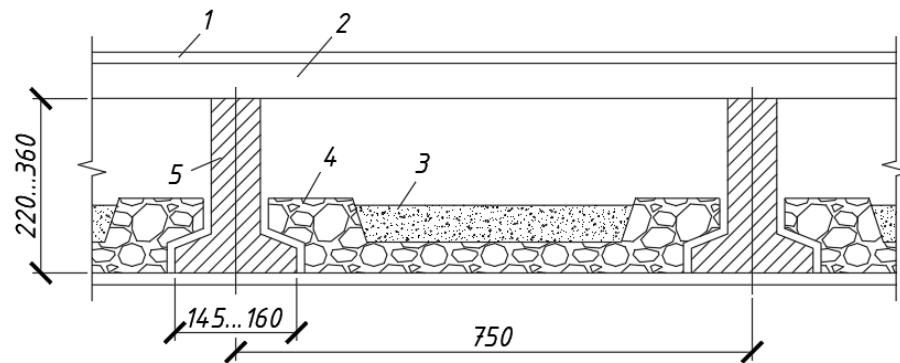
Конструкції для заміни перекриттів з залізобетонними прогонами таврового перетину: 1 - дерев'яна підлога; 2 - дерев'яні лаги; 3 - утеплювач; 4 - легкобетонна плита-вкладиш; 5 - залізобетонний прогін таврового перетину
